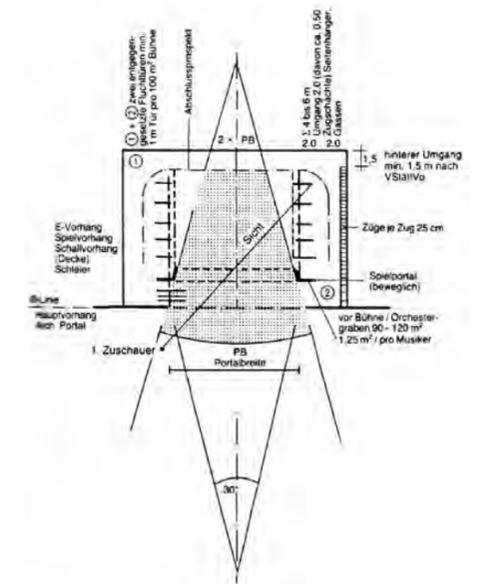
Proportionen der traditionellen Bühne in der Aufsicht/ Grundriss
